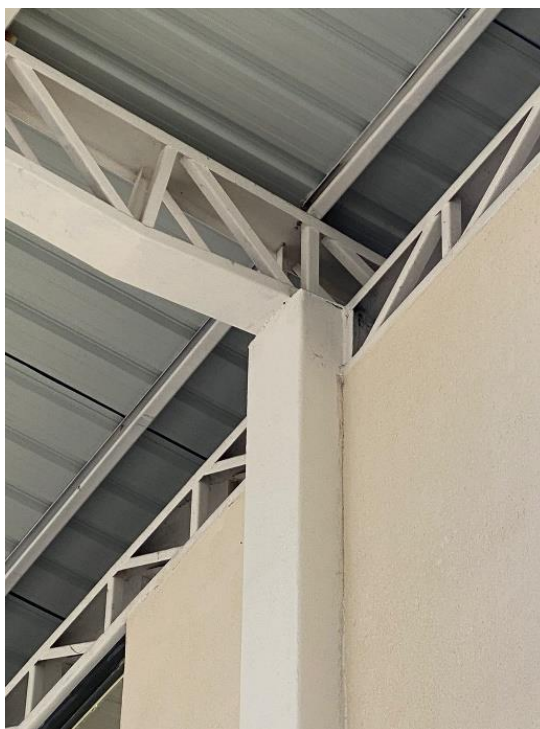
11: Unión entre cerchas y columnas del sistema estructural de la edificación 19
